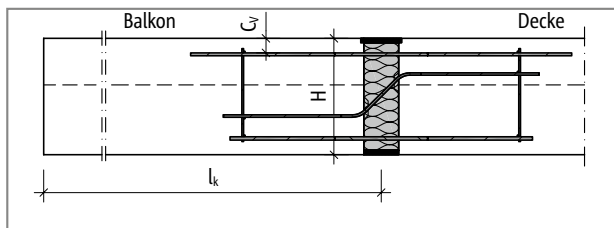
Schöck Isokorb® XT Typ BP: Statisches System
